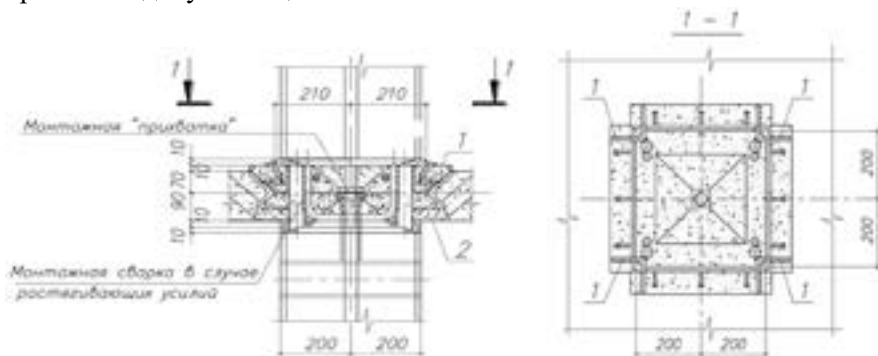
Стык колонны с надколонной плитой перекрытия:
